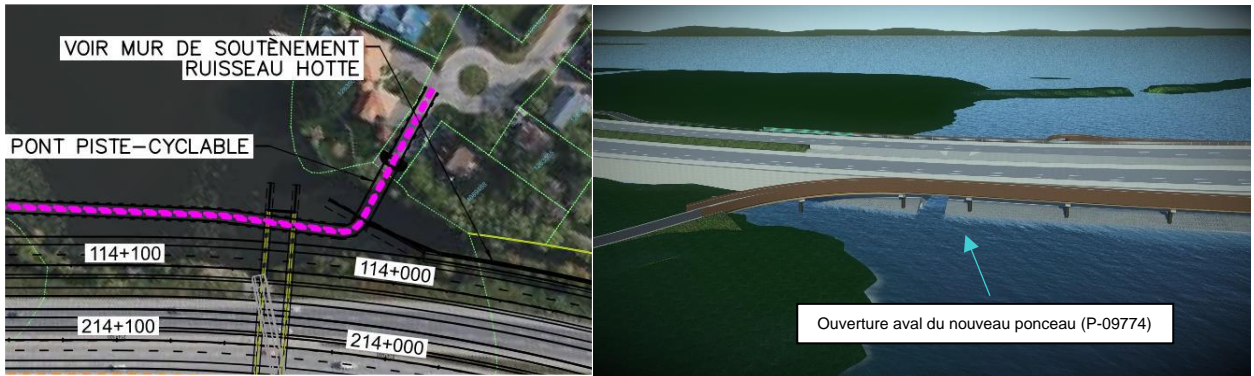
Concept de passerelle traversant l'embouchure du ruisseau Hotte
